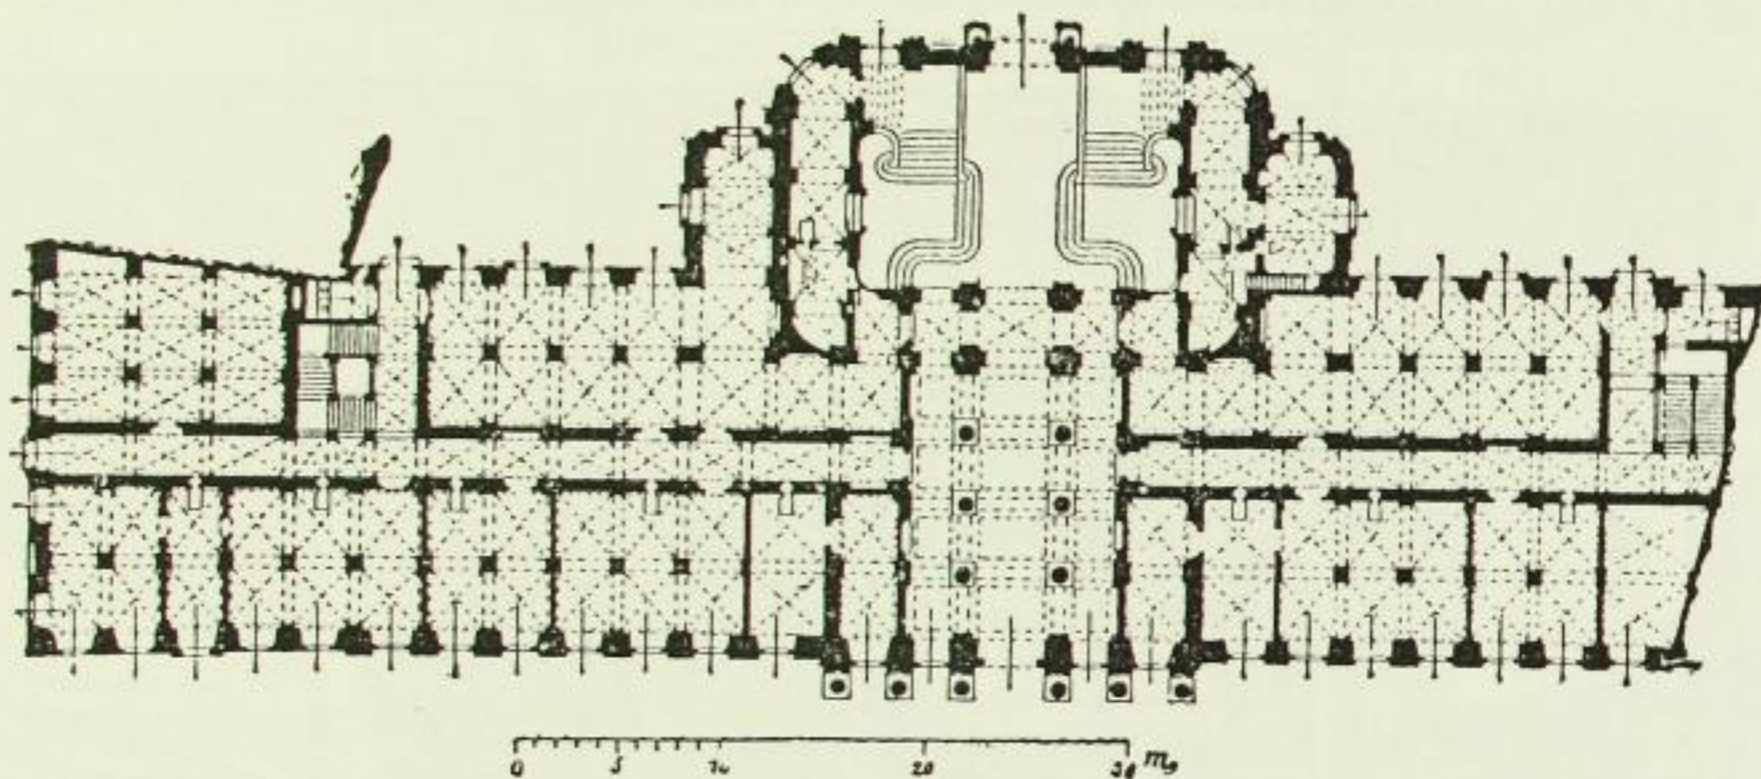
Landhaus, Grundriss des Erdgeschosses.
